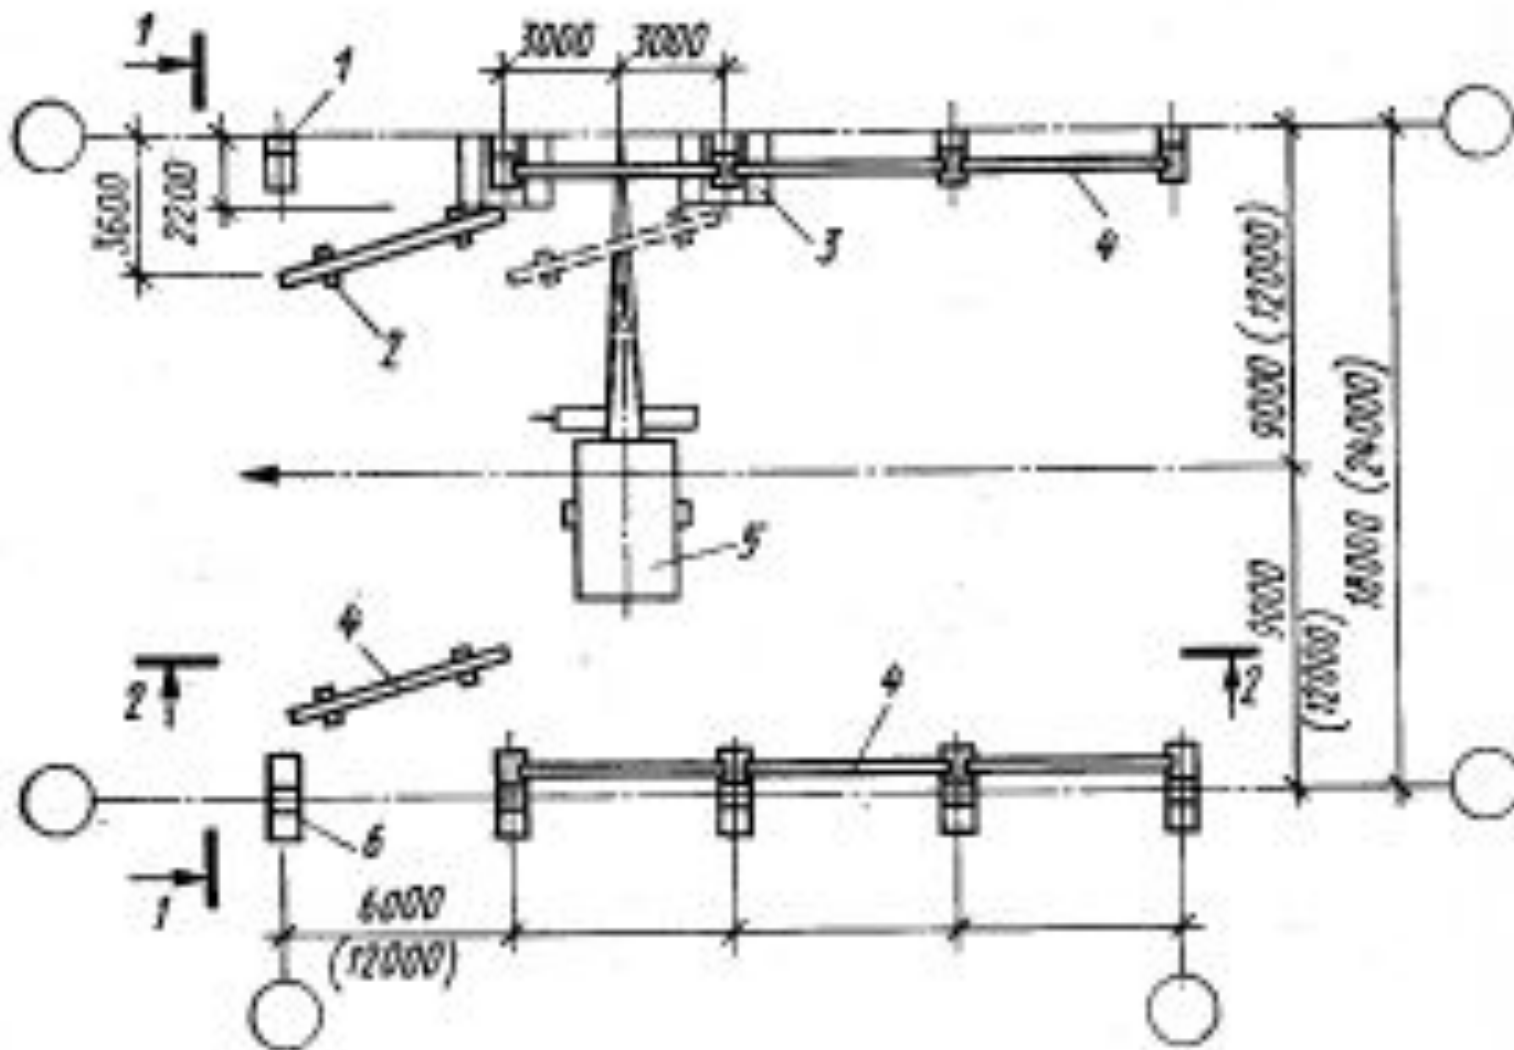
Схема выгрузки и раскладки подкравовых балок пролетом 6 и 12 м:
